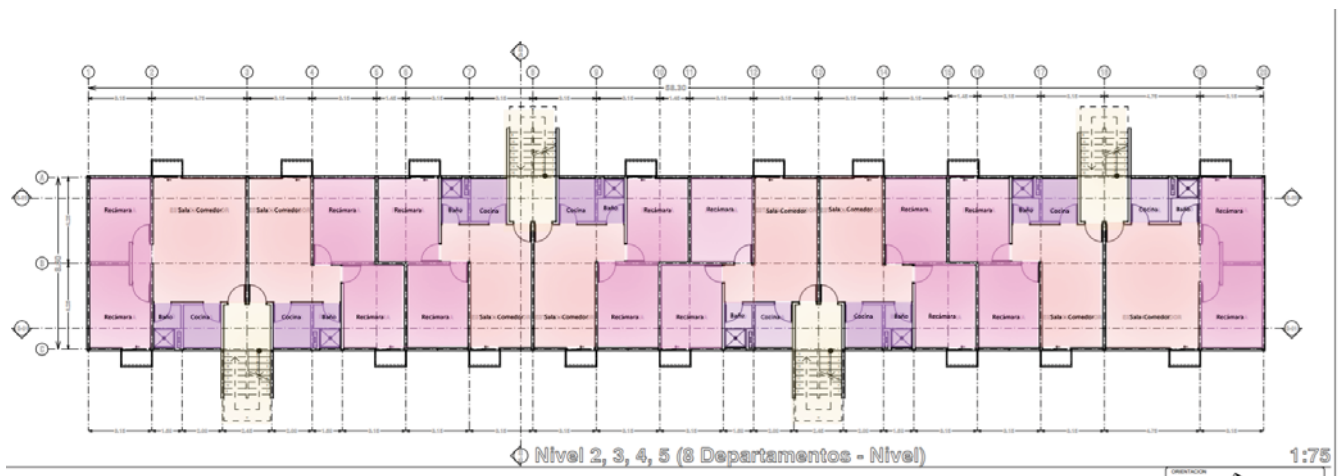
Planta tipo de los edificios 2A, 2B y 2C
